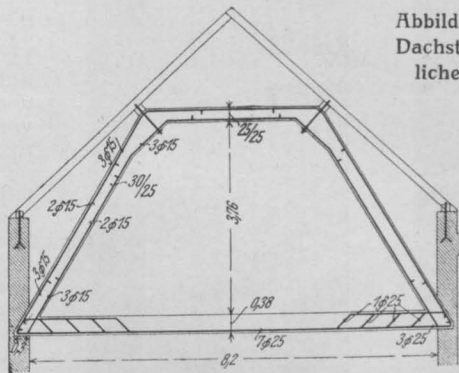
Eisenbeton-Dachstuhl über dem seitlichen Ausstellungssaal.
